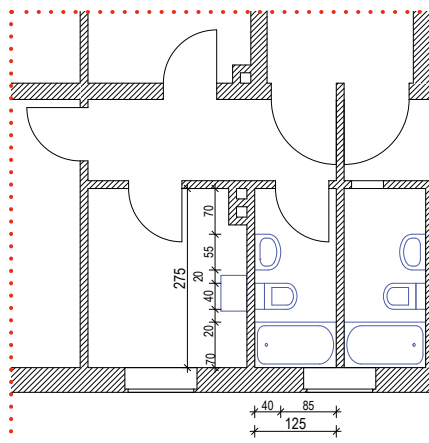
Detail Bad Ingolstadt, Brucknerstr. 2–4
